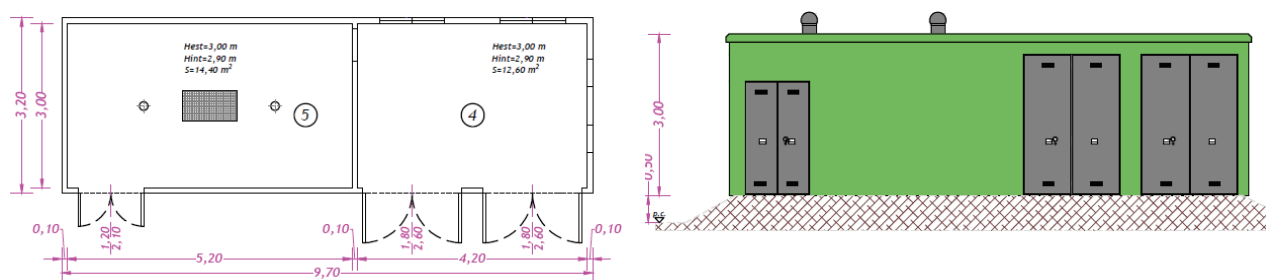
Pianta e profilo delle cabine MT/BT
